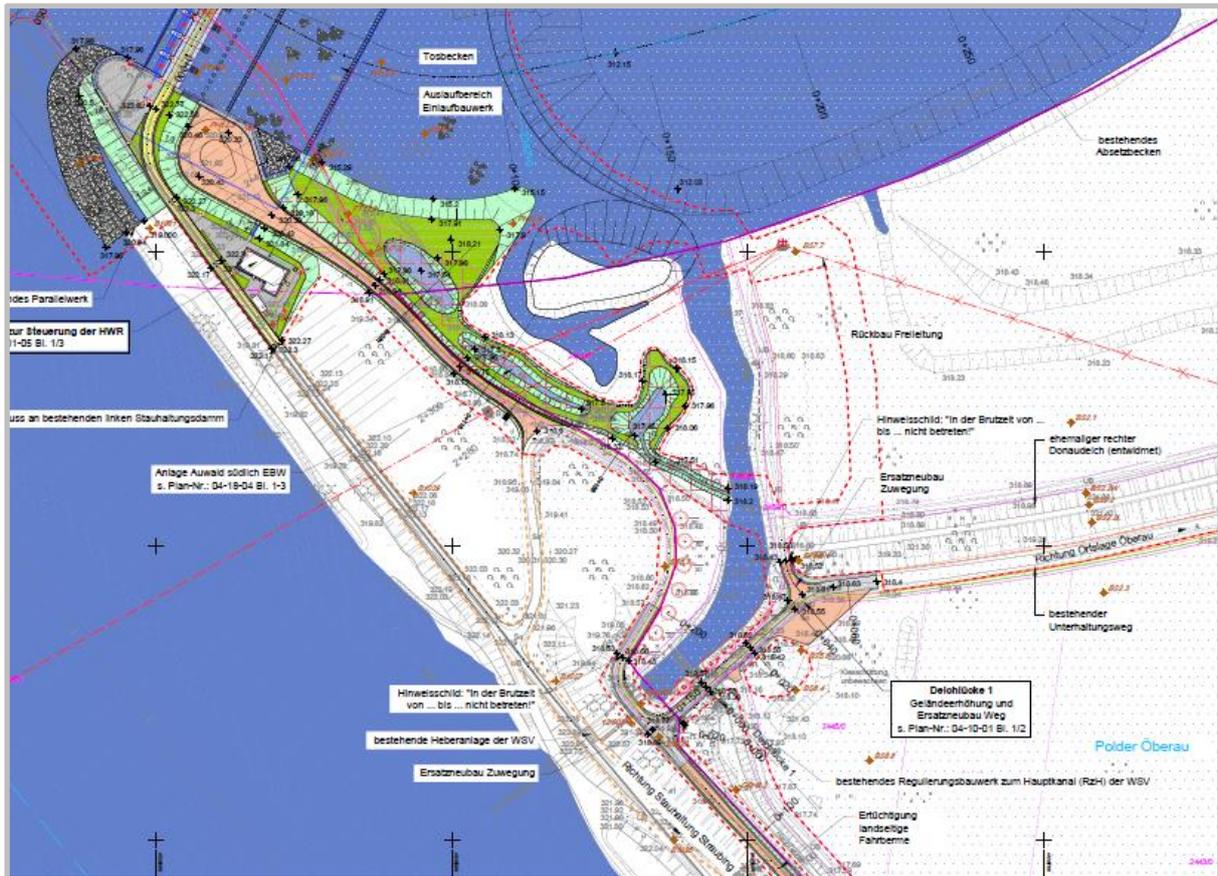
Vorhandene und zukünftige Wegeverbindungen im Bereich des Einlaufbauwerkes auf der Grundlage des Lageplanausschnittes gemäß Plan-Nr. 03-03-01, Blatt-Nr. 1/1
